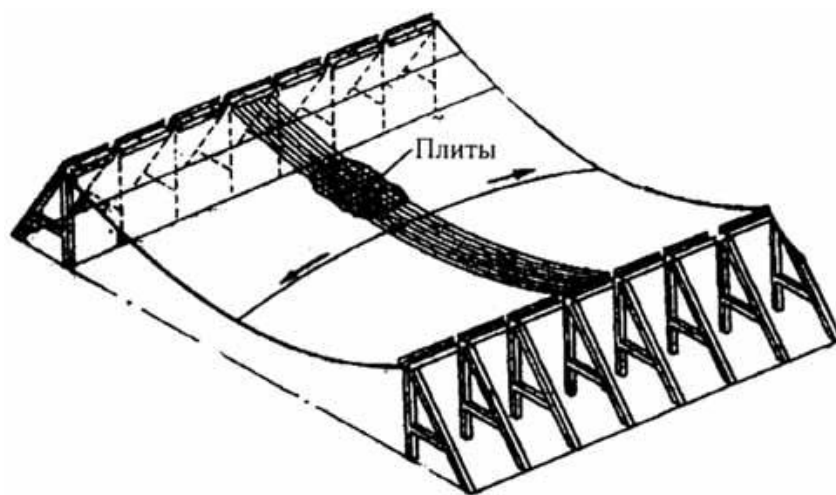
Схема расположения вант и укладки сборных железобетонных плит над стоянкой гаража 78×84 м, 1963-1965
